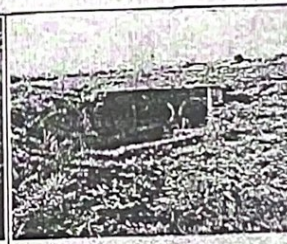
P5 local oposto ao P1 da galeria de águas pluviais.
